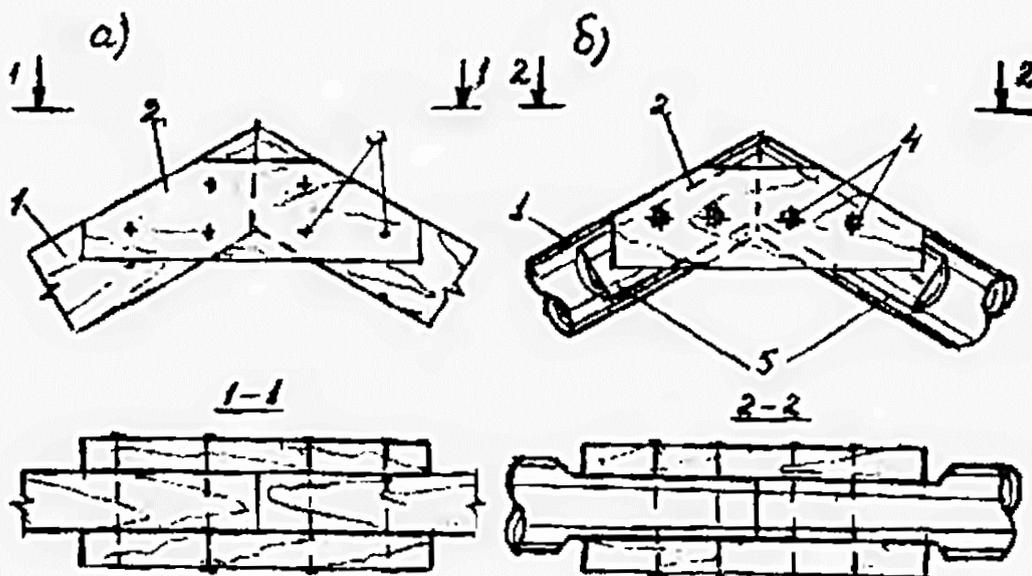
Стык стропильных ног в коньке при отсутствии конькового прогона и стропилах: а – из брусев и досок; б – из бревен; 1 – стропильная нога; 2 – накладка; 3 – гвозди 5x150; 4 – болт М16; 5 – стеска
